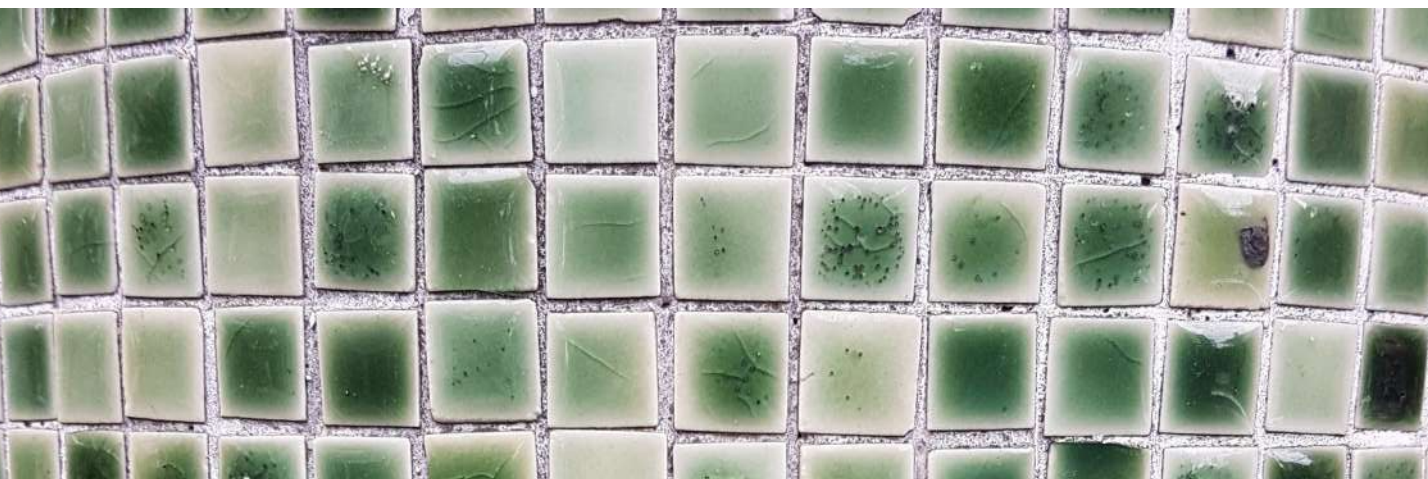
Pastilhas de vidro no revestindo pilar. Fonte: Autora, 2020.
